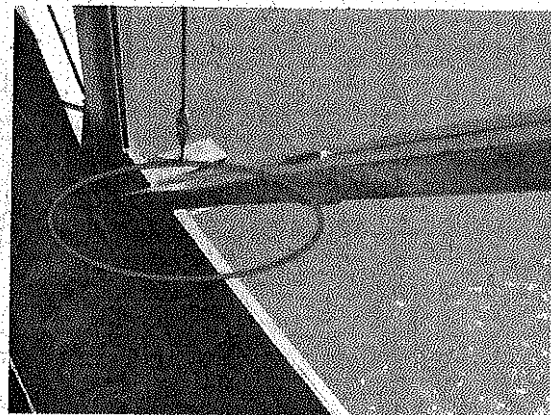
04/12/2017: Rastros de corrosión en elementos metálicos.
